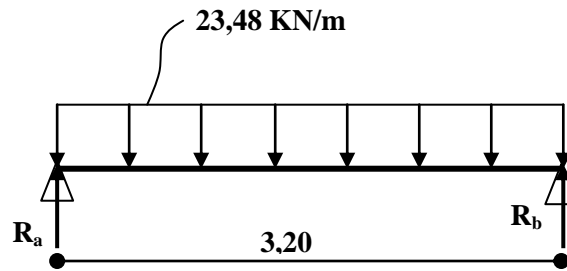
Schéma statique de la poutre palière (ELS)
